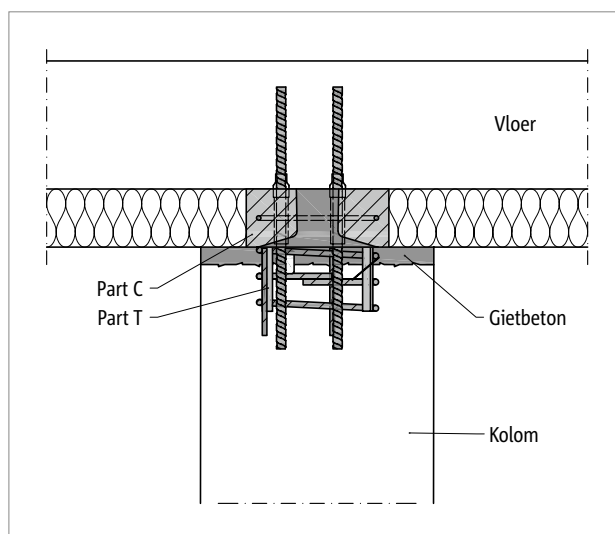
Schöck Sconnex® type P: Aansluiting kolom aan de rand op bovenliggende vloerplaat
